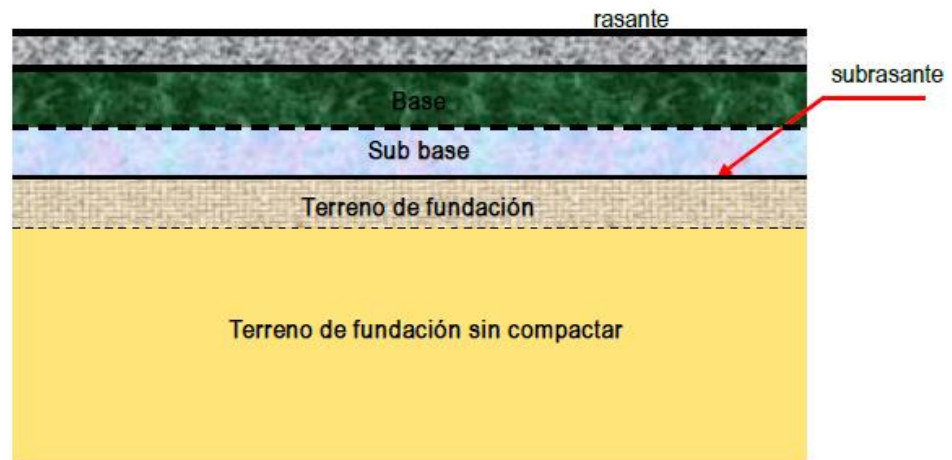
Modulo estructural de los pavimentos (Minaya & Ordoñez, 2016)
